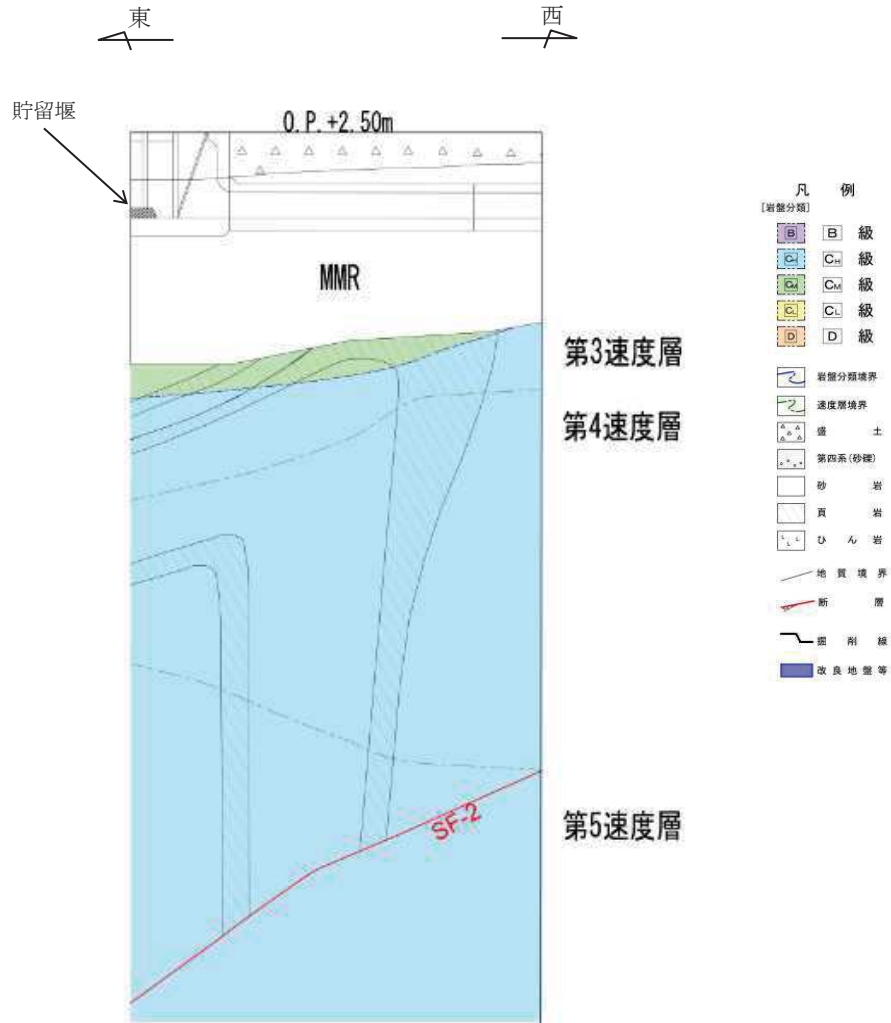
貯留堰（取水口）地質断面図（B-B）
